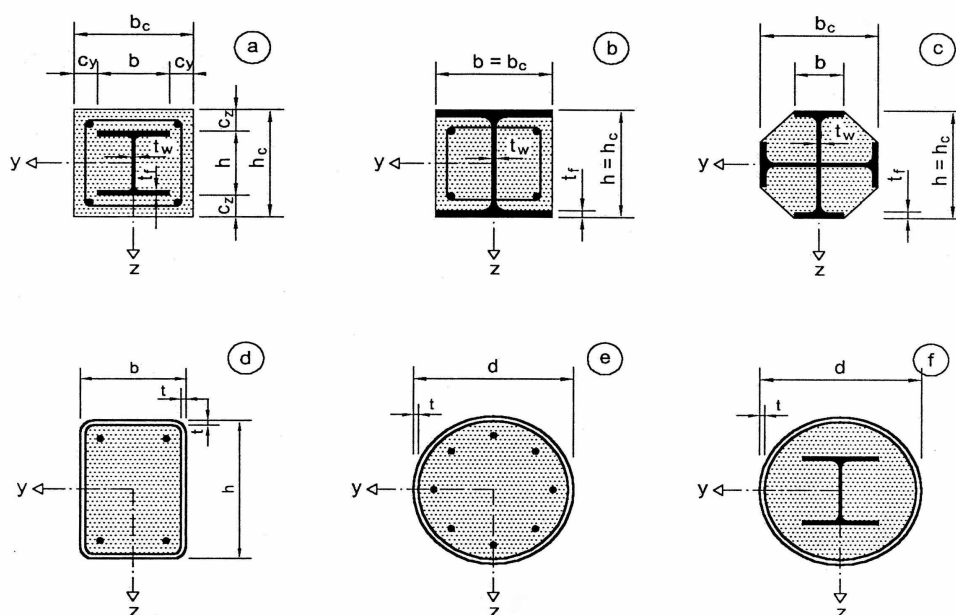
Seções transversais típicas de pilares mistos de aço e concreto.
